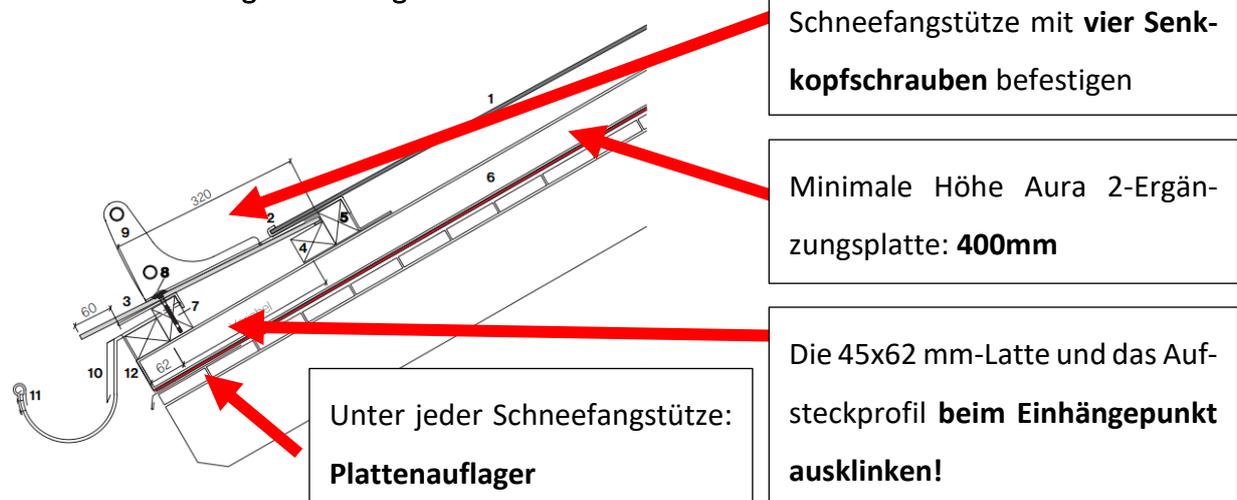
Schneefangvorrichtung (Quelle: Swisspearl Details Sunskin Roof Lap)
